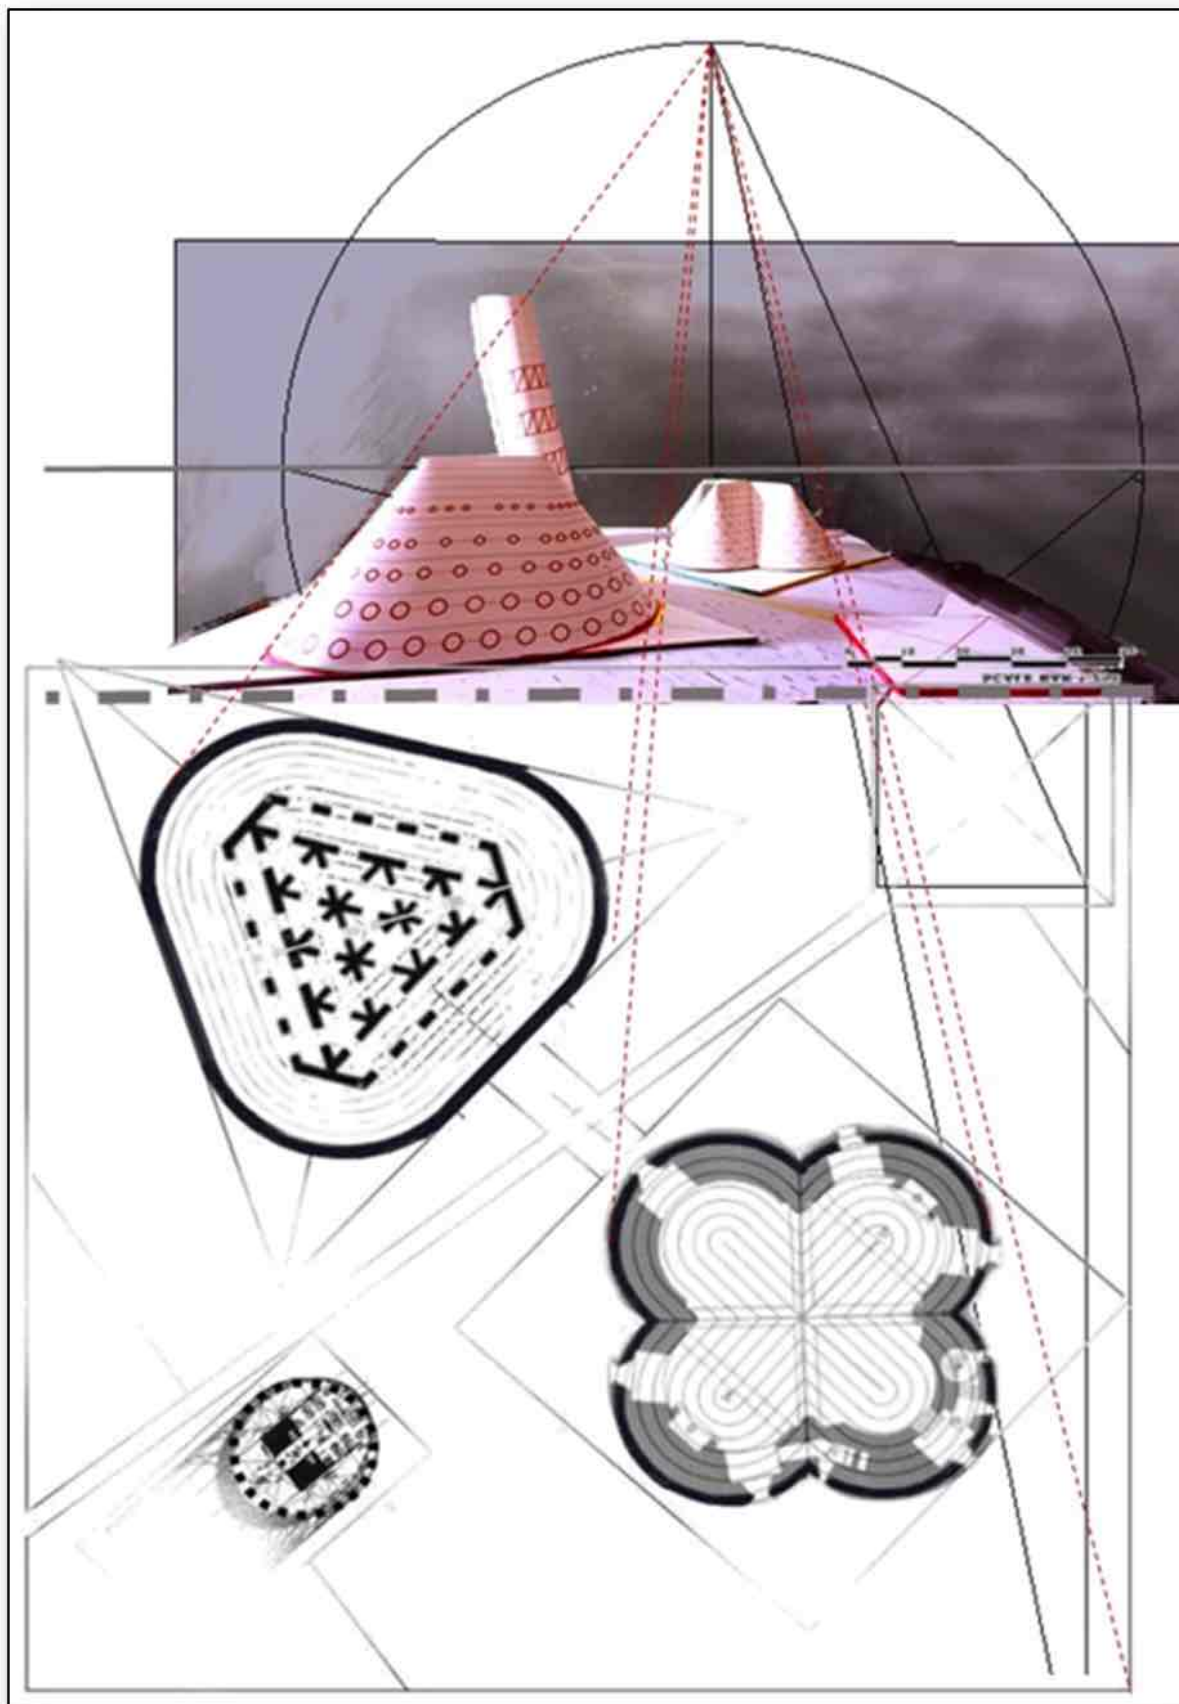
esempio di una omologia che lega la pianta prosettica di una foto frontale dell'intero modello alla sua sezione planimetrica in vera forma.
